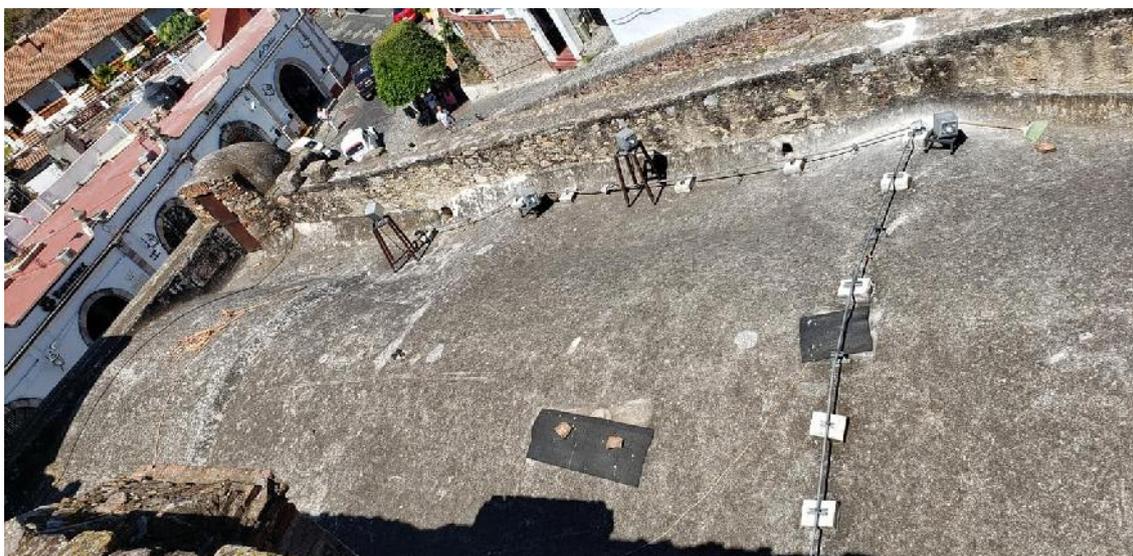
Pérdida de elementos en nave principal. Foto 08. Cubierta nave
